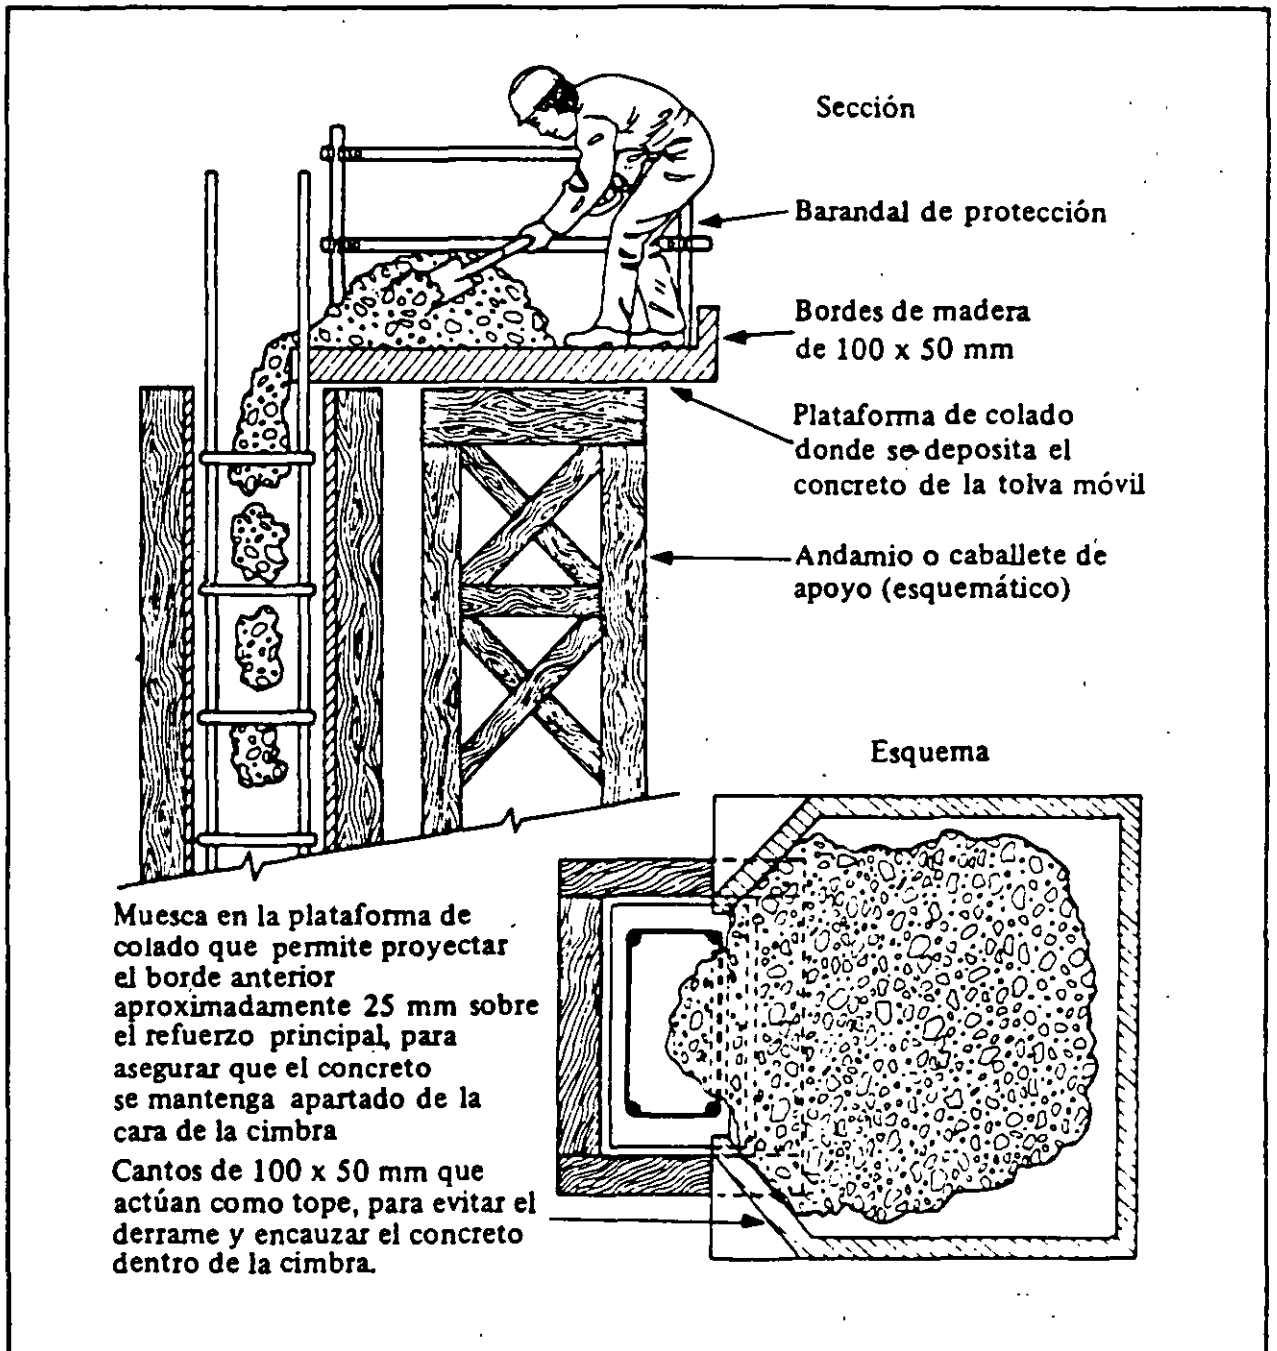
Empleo de una plataforma de colado en la parte superior de una columna. En muros delgados puede emplearse una distribución similar pero con una plataforma de colado extendida.
